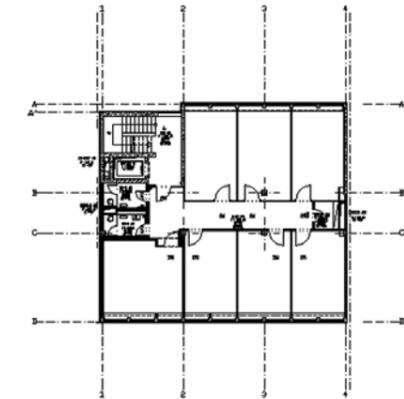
Corneliusstraße 9, Gebäudebestand und Grundriss Bestand
